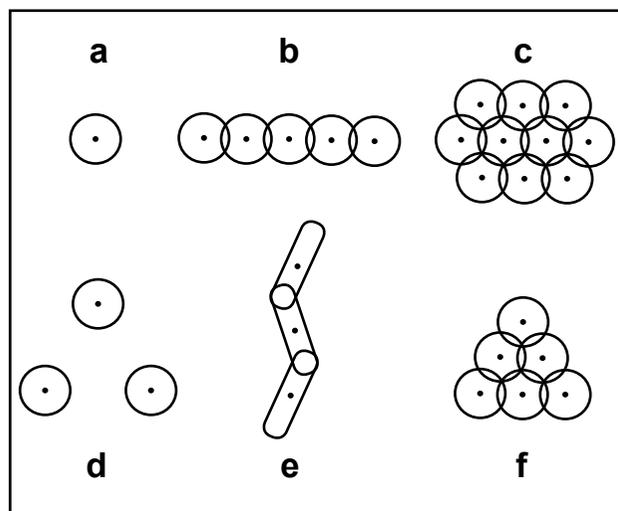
Arranjos típicos de aplicações de Jet Grouting.
